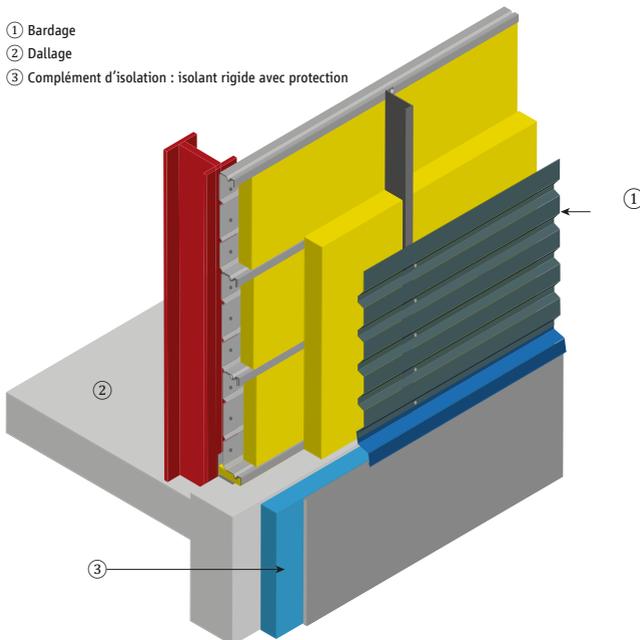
Exemple de solutions de correction de ponts thermiques à la liaison entre une façade et un dallage
